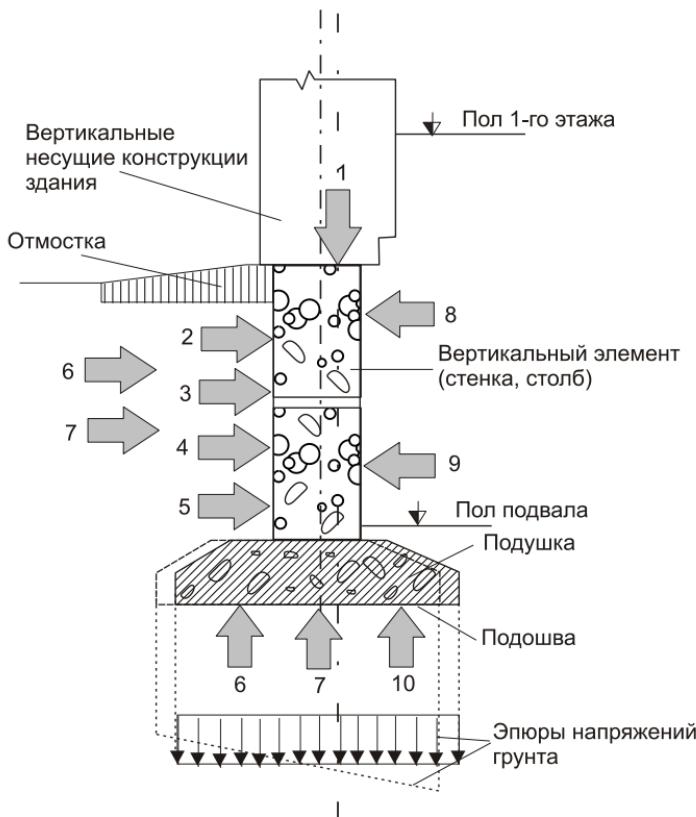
Воздействия на фундаменты: 1 — нагрузка от здания; 2 — боковое давление грунта; 3 — сейсмические нагрузки; 4 — силы пучения грунта; 5 — упругий отпор грунта; 6 — вибрации; 7 — температура грунта; 8 — температура помещения подвала; 9 — влага воздуха подвала; 10 — влага грунта, агрессивные примеси в воде и воздухе, биологические факторы
